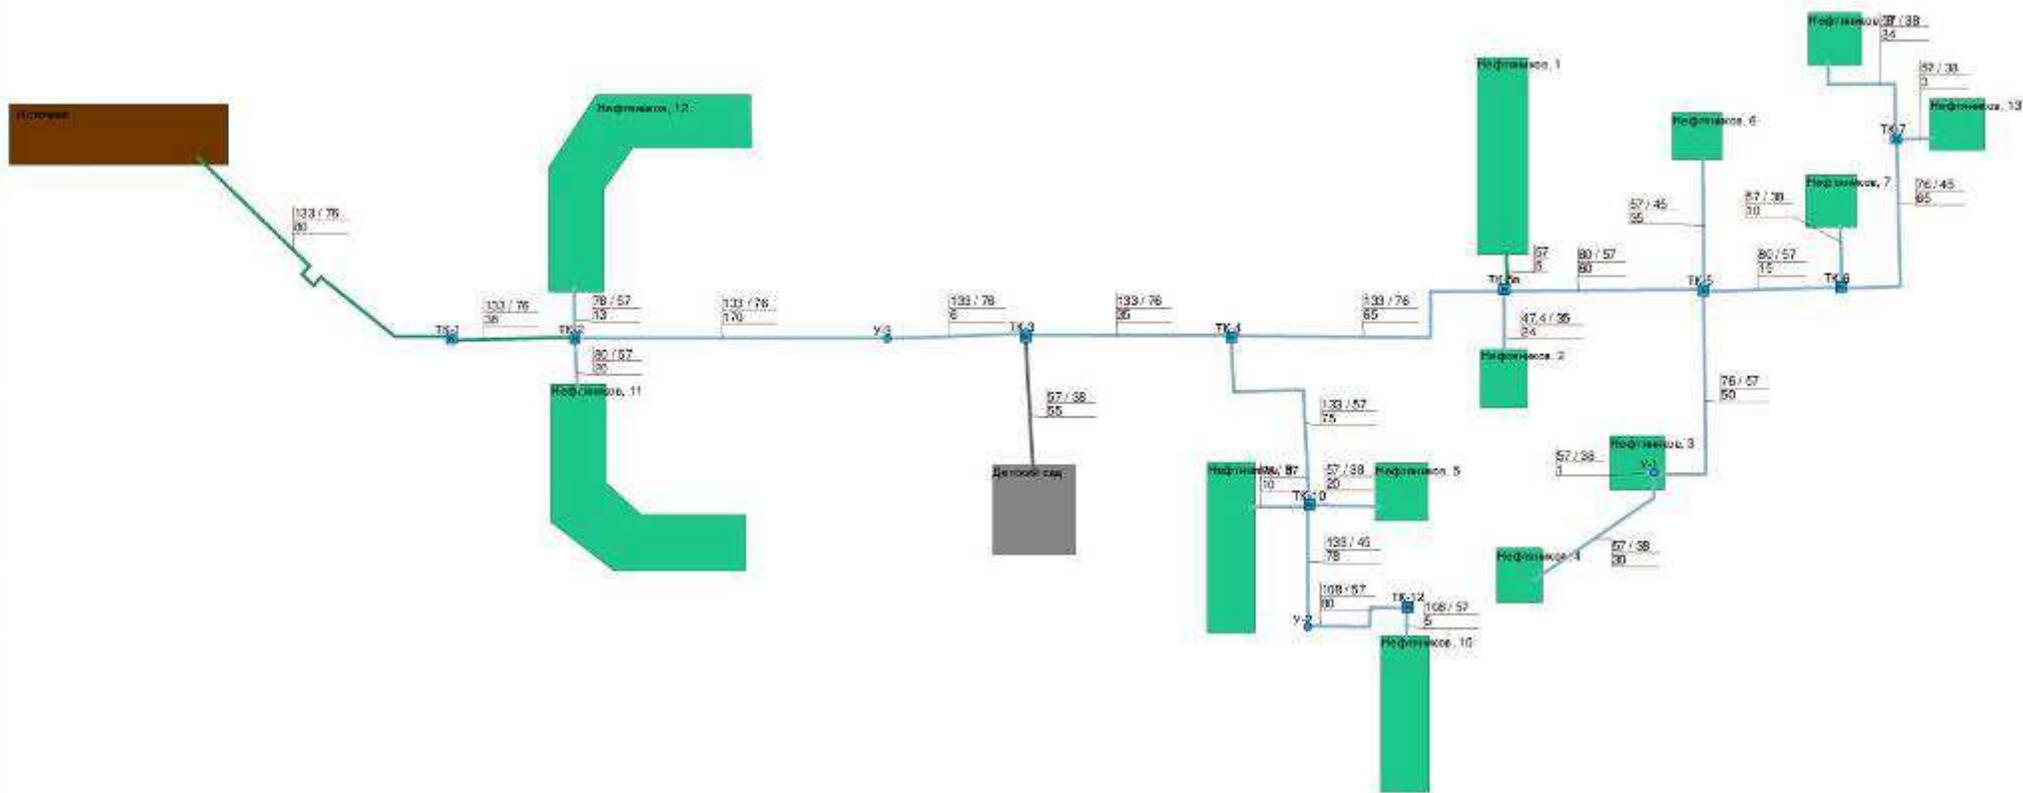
Схема теплоснабжения п. Кузнечиха нижняя (ГВС) в режиме наладки с заменой трубопроводов
